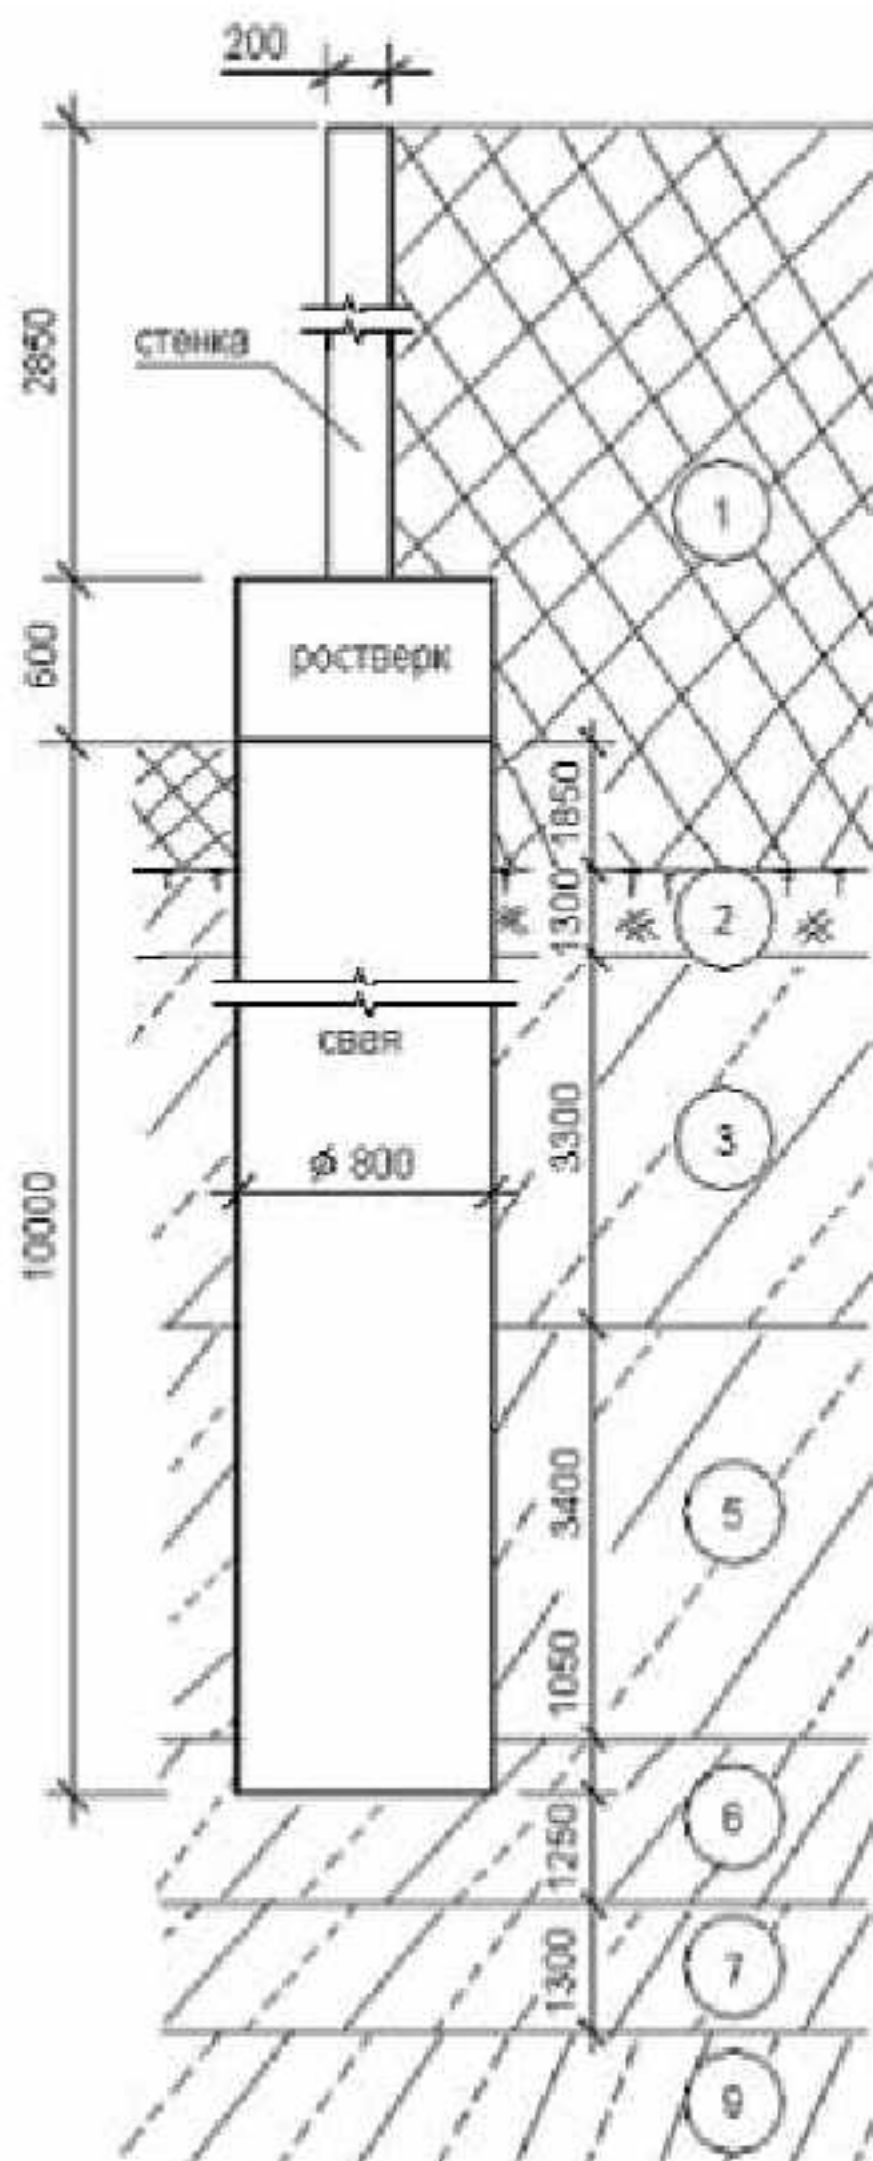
Вид стенки (вариант 2.3) с посадкой на инженерно-геологический разрез.
